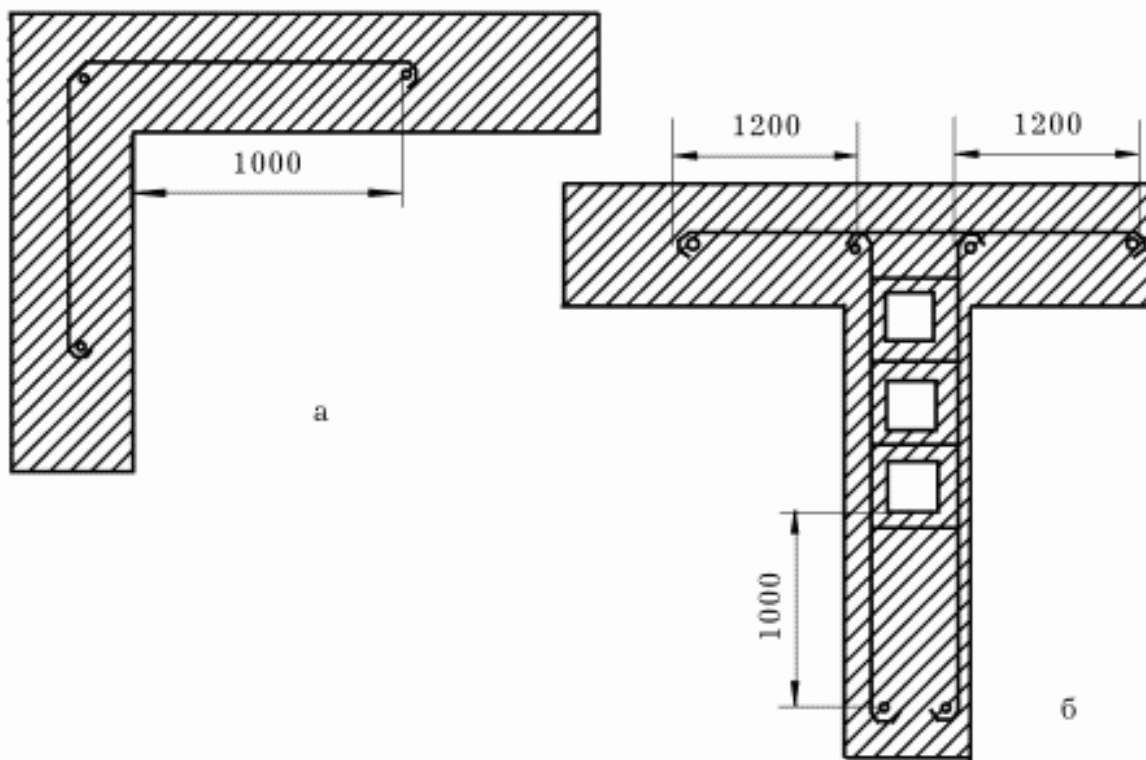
Укладывание стальных связей в углу и примыкание внутренней стены к наружной (размеры даны в мм): а – в углу; б – в местах прохождения каналов.
